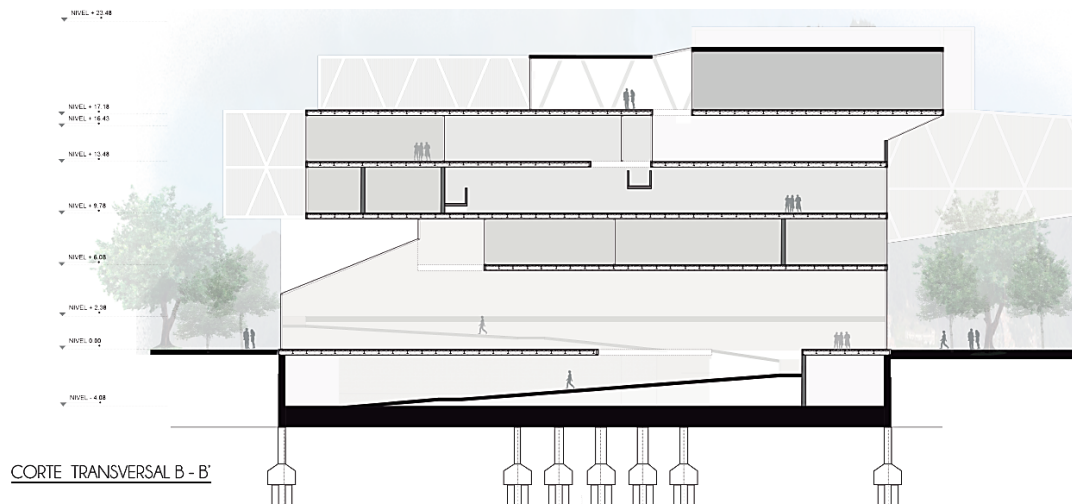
Centro I.D Corte Transversal B-B' Sección por rampas. Autoría Propia
